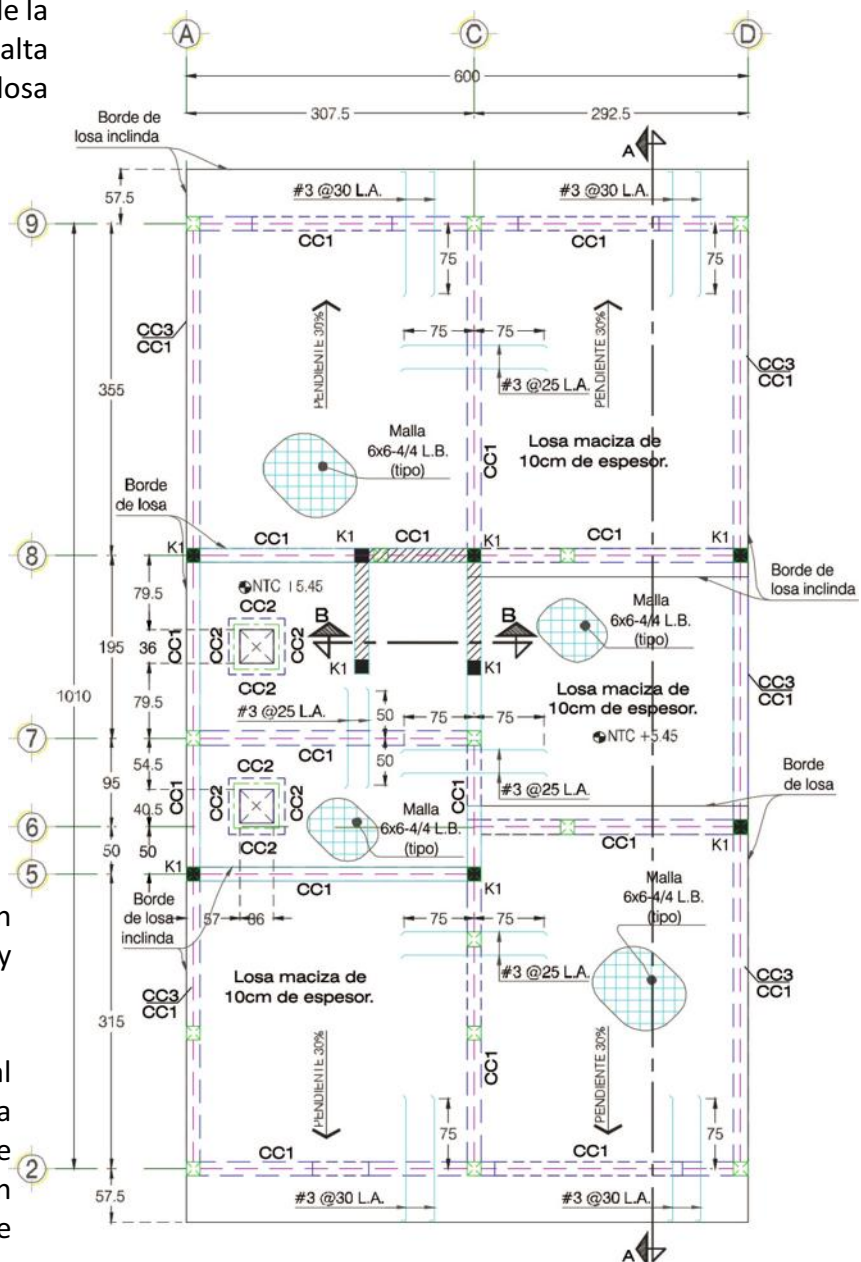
PLANTA LOSA DE AZOTEA ROBLE//IMAGEN PLANO ESTRUCTURAL MOD. ROBLE//TRES MARIAS
